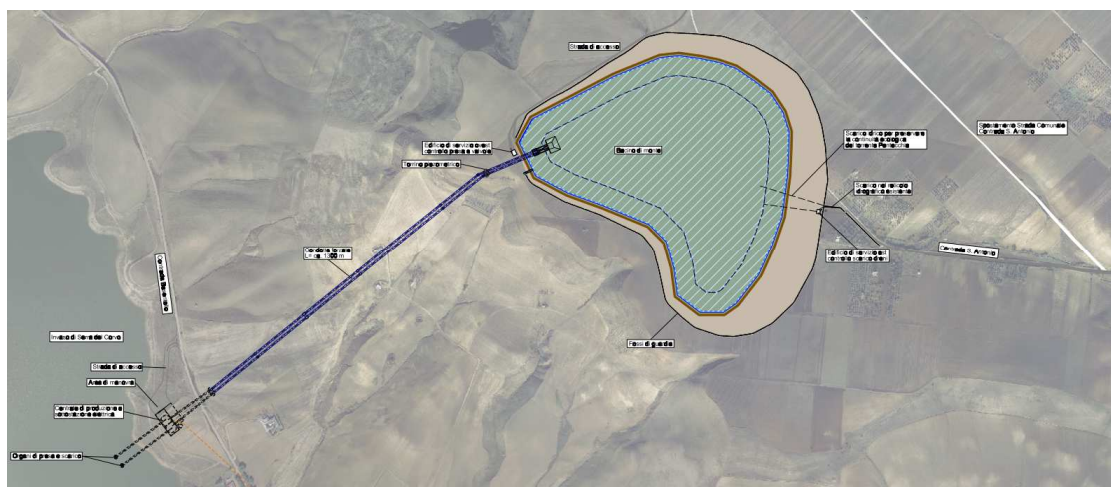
Estratto della planimetria di progetto (PD-EP.3.1).
